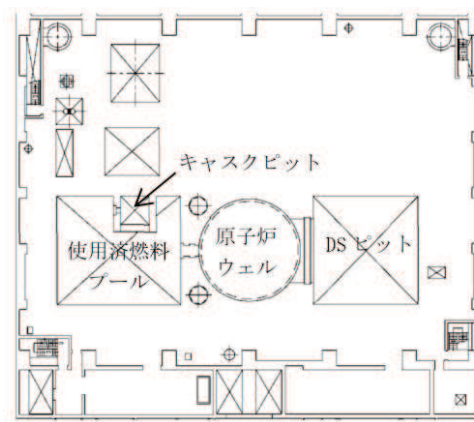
原子炉建屋 3 階の機器配置図 (平面図)
